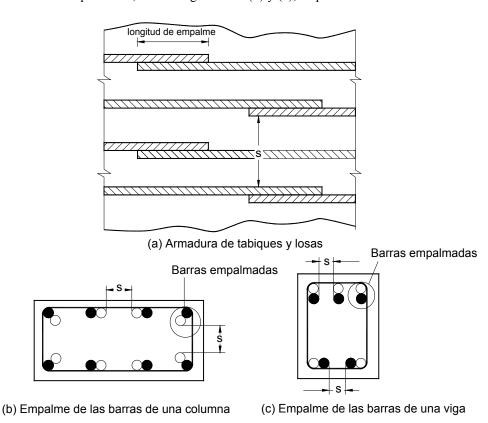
Separación libre efectiva de las barras empalmadas
